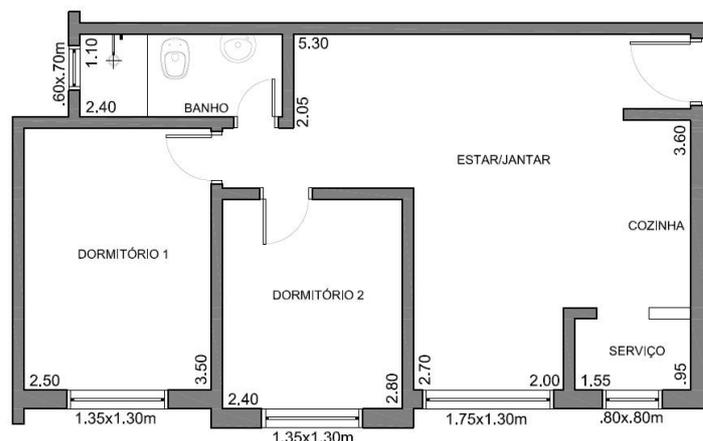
Planta baixa da unidade habitacional padrão do conjunto.
